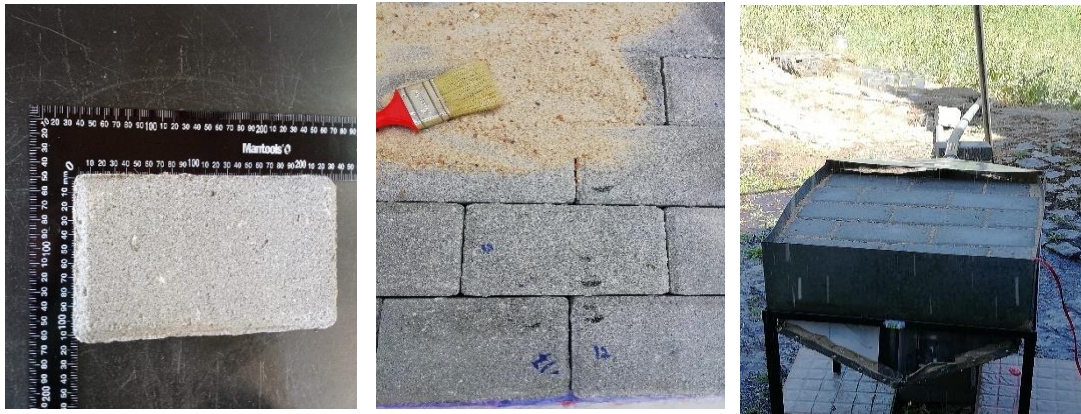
Pavimento permeável construído com blocos de cimento retangulares
